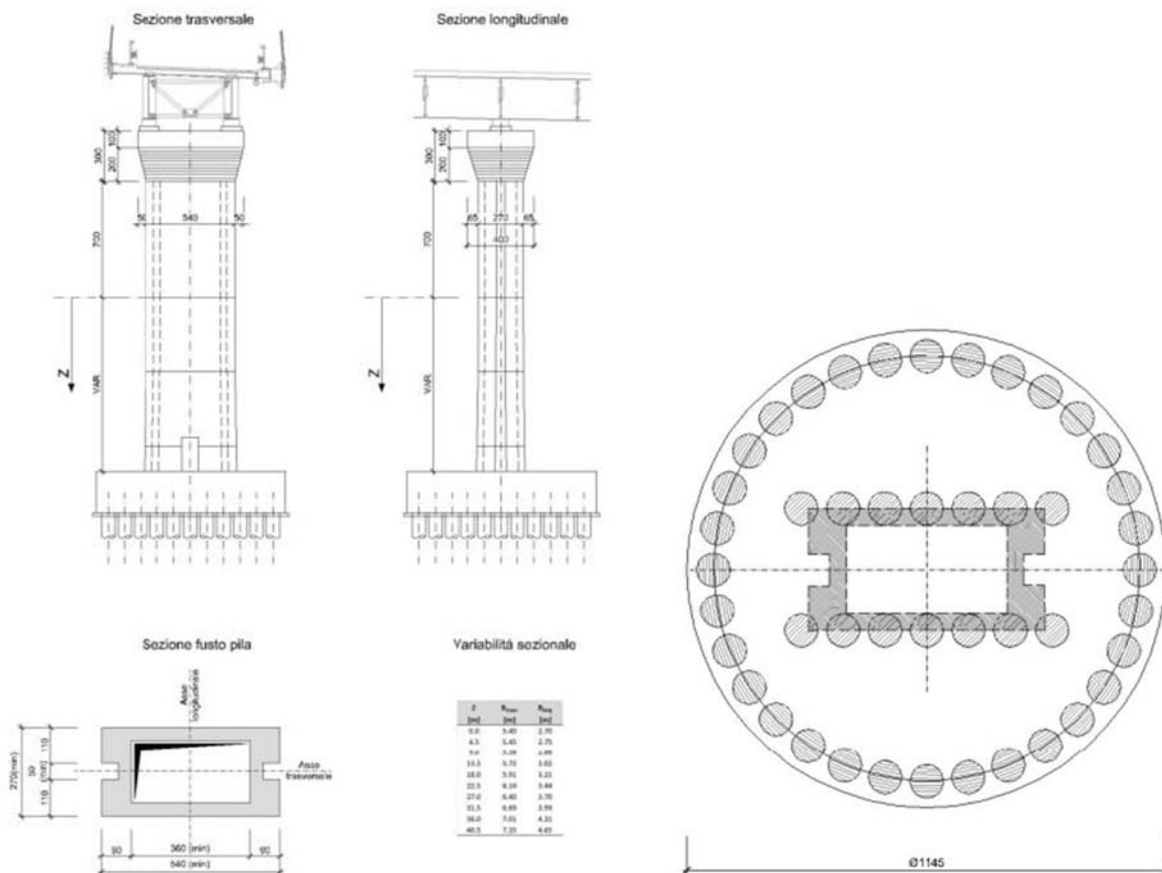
Inquadratura generale geometria pile e fondazioni Viadotto B
